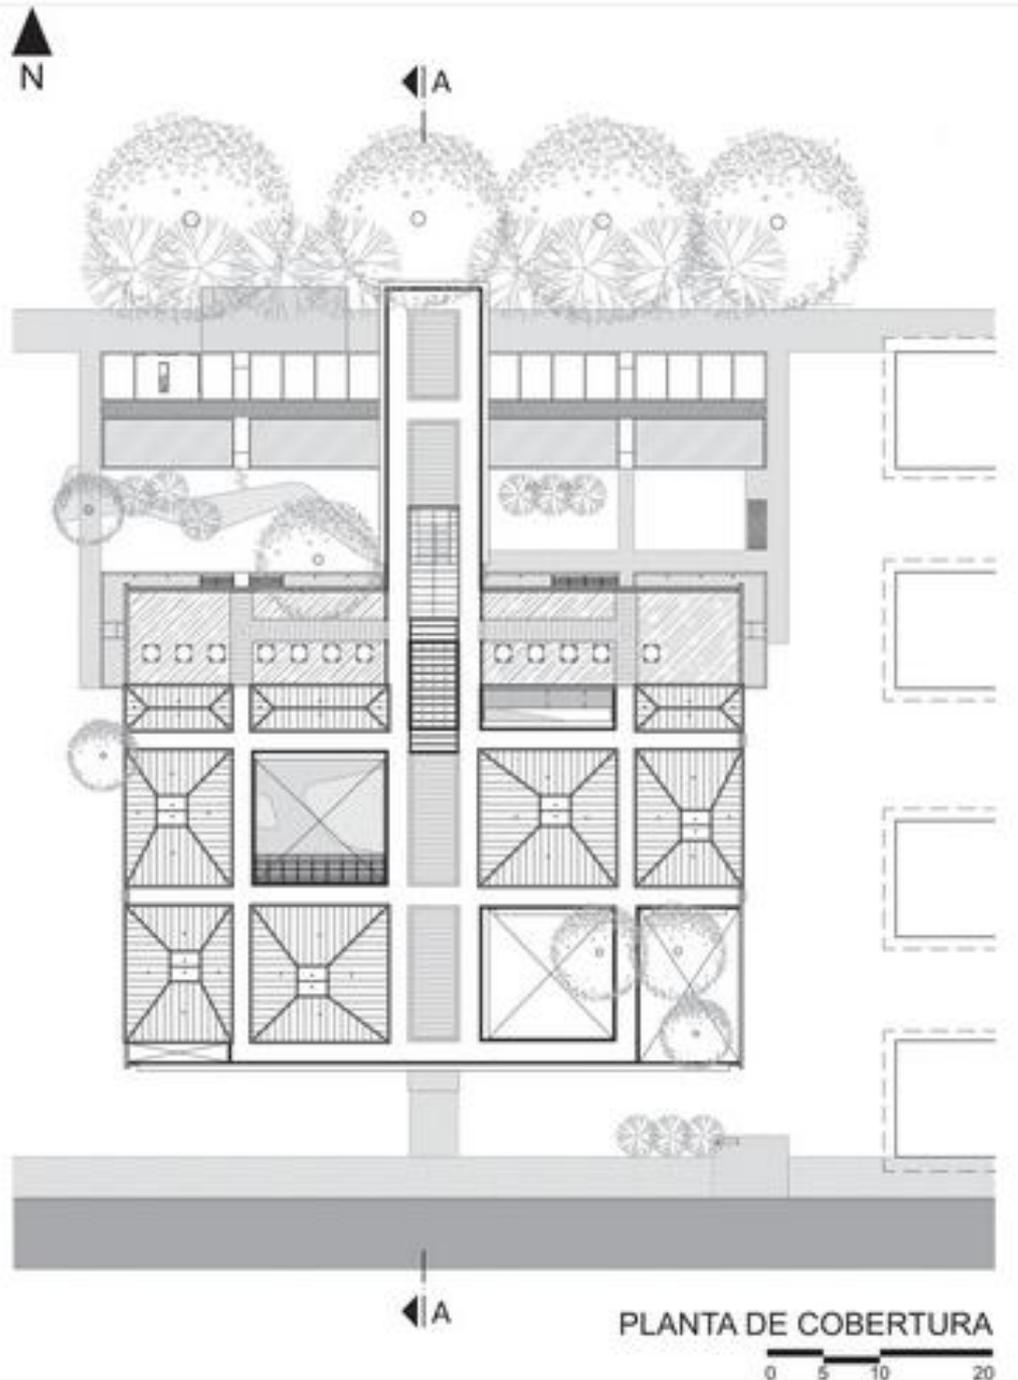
Planta baixa da biblioteca Paulo Freire.
